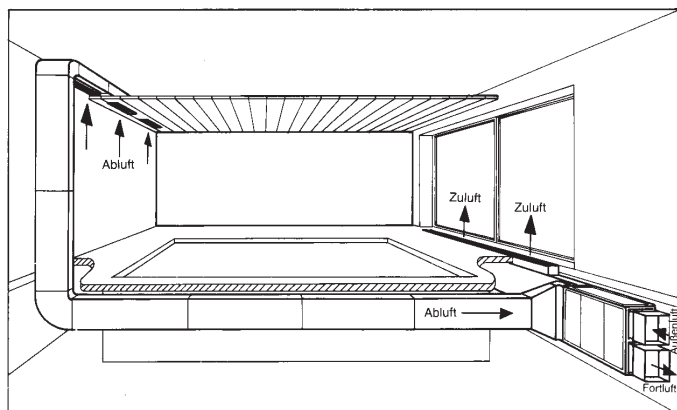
Общеобменная вентиляция и осушение внутреннего воздуха в плавательном бассейне
